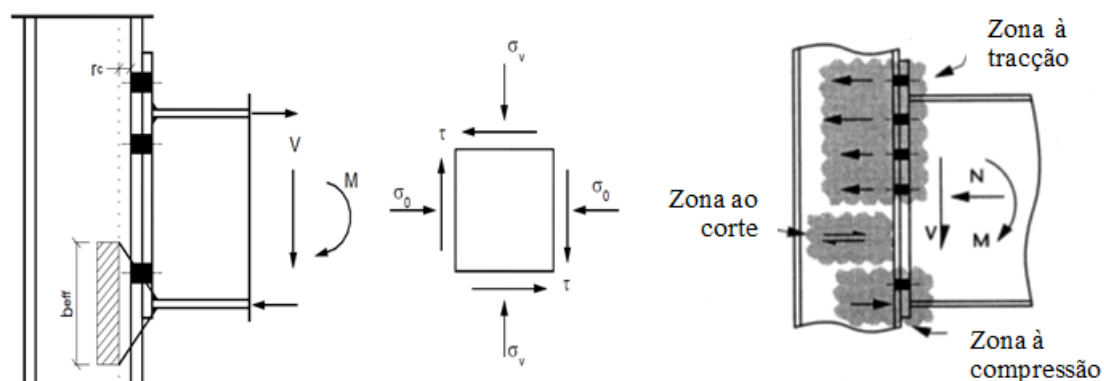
Tensões normais e de corte na alma do pilar [15; 1]
